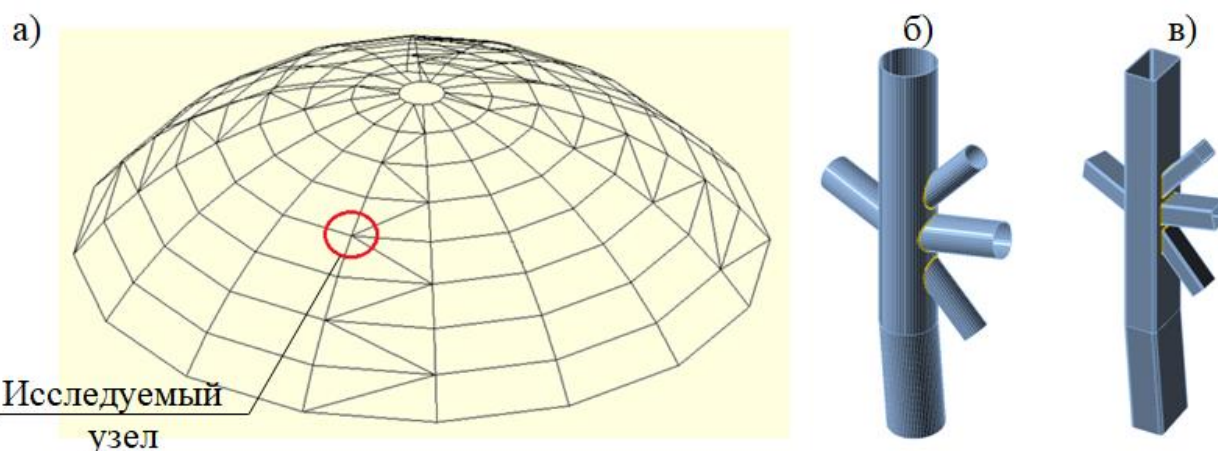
Объект исследования: а) конструкция покрытия; б) исходный вариант конструкции узла из круглых труб; в) исходный вариант конструкции узла из гнутосварных труб прямоугольного сечения
